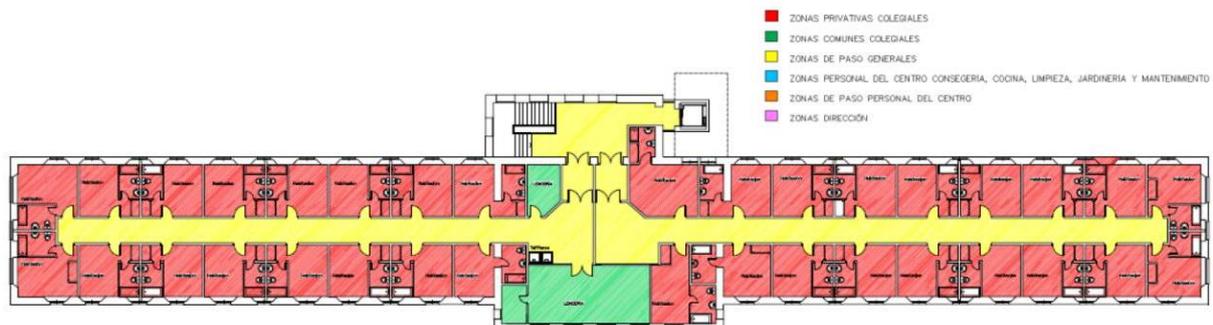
Plano de Usos Planta Tercera del colegio mayor Hernando Colón. Fuente: Archivo C.M.H.C
